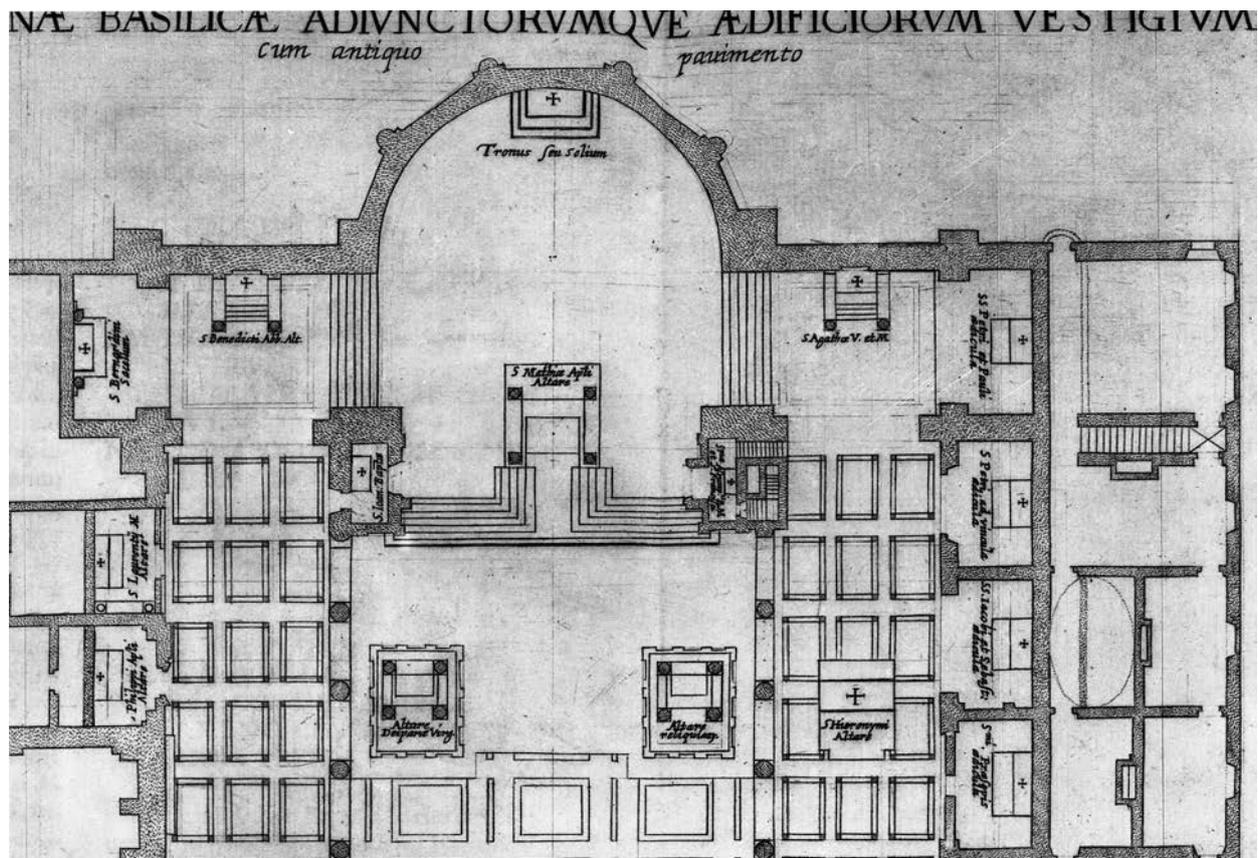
Rom, S. Maria Maggiore, Grundrissdetail des Apsis- und Querhausbereichs (nach De Angelis 1621)
